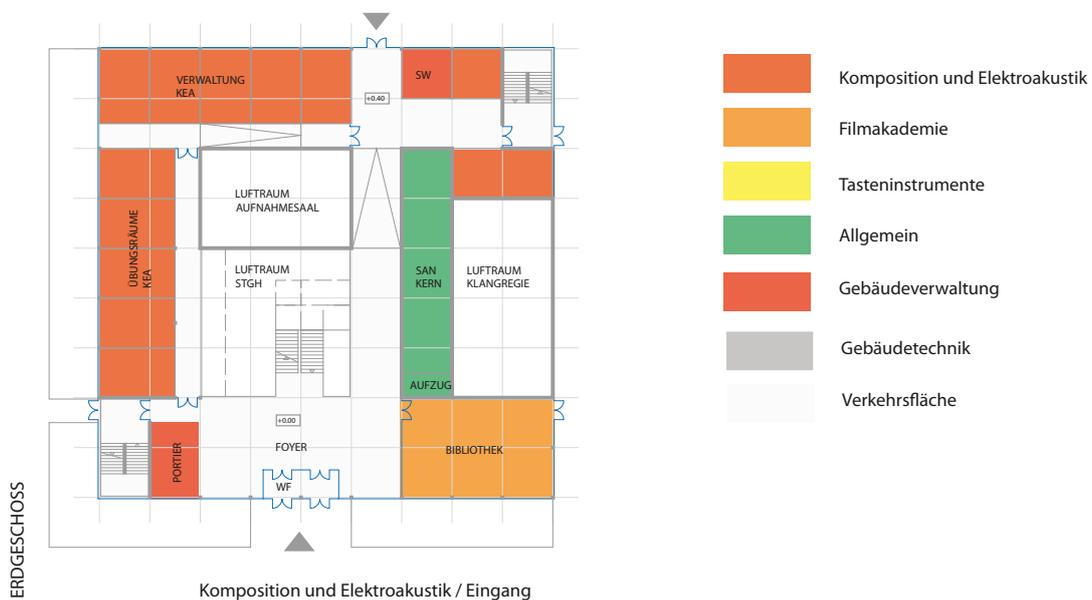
Vorentwurf _ Grundriss EG
